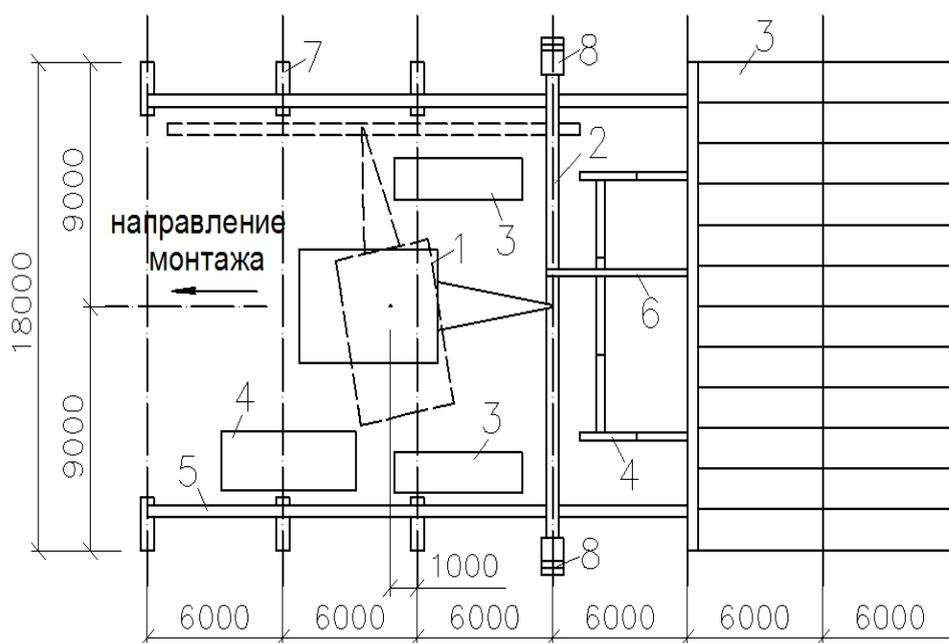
Схема монтажа здания фильтров водоочистной станции: 1 – кран; 2 – стропильная ферма; 3 – плиты покрытия; 4 – стеновые панели фильтра; 5 – подкрановая балка; 6 – распорка; 7 – колонна; 8 – лестницы приставные с площадками
